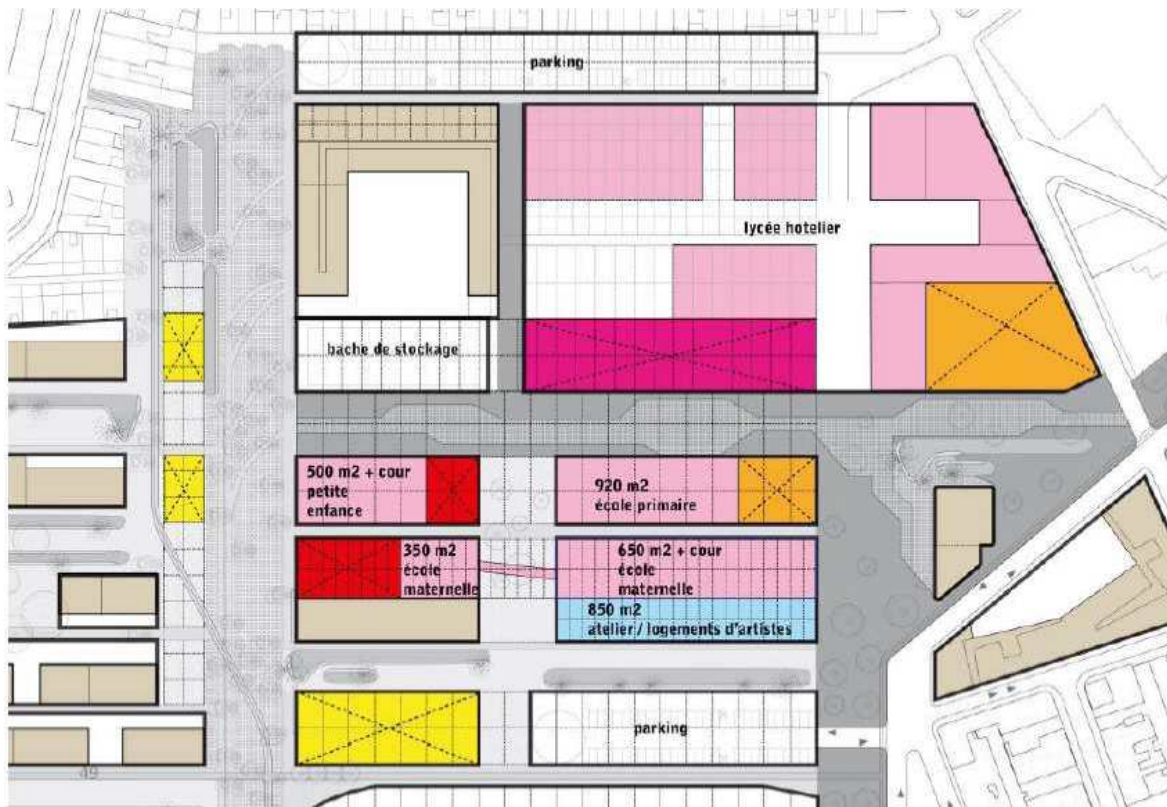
Localisation des équipements sensibles - Plan programme de la zone nord du site - Plan du R+1 (Source : L'AUC, urbaniste du site, mars 2010)
